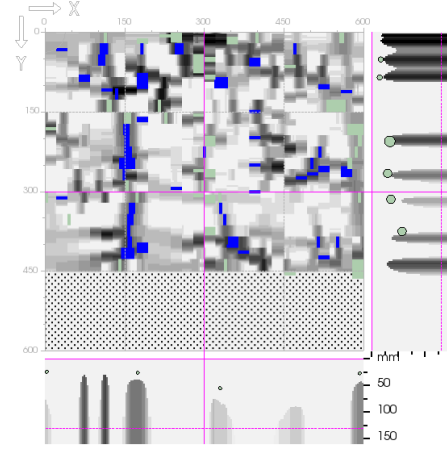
Poutre Pt02 – Travée 3 à mi-travée
